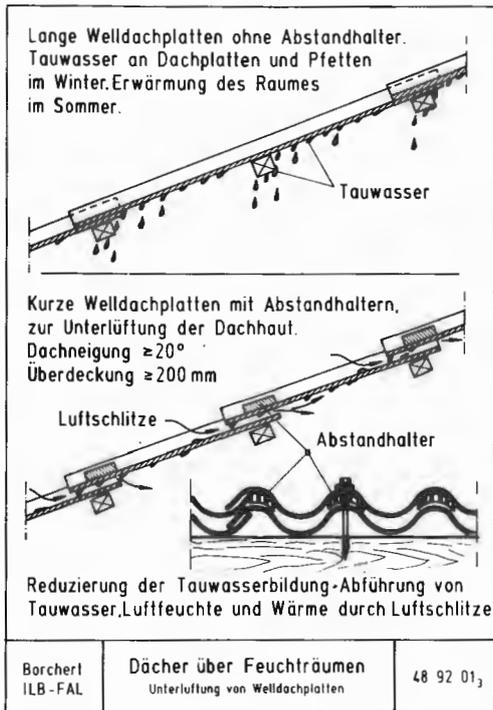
Dächer aus Faserzement-Wellplatten über nicht-wärmegeprägten Ställen. Oben: ungeeignete Konstruktion. Unten: Verlegung kurzer Platten mit Abstandhaltern zur Unterlüftung der Dachhaut, Verminderung der Wärme- und Feuchtigkeitsbelastung des Daches
